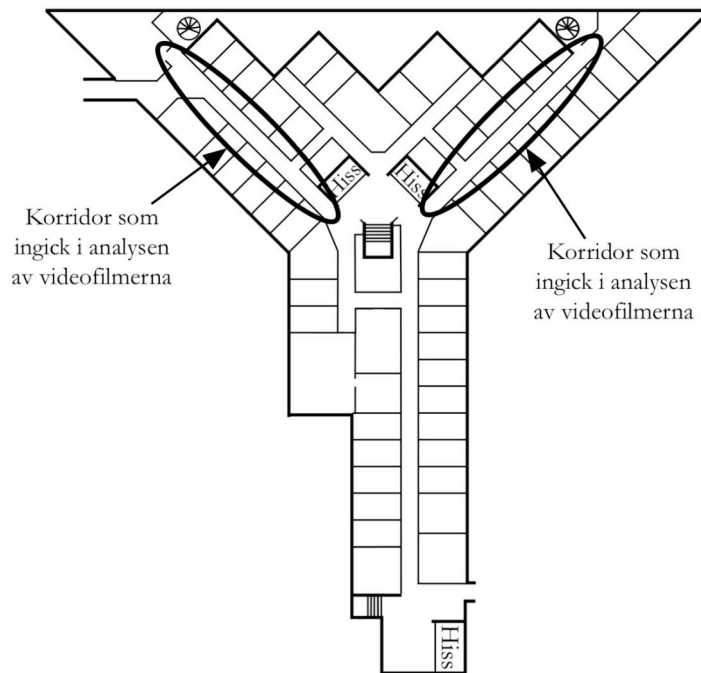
Kamerornas placering på plan 3, 4, 6 och 7 i byggnad KC
